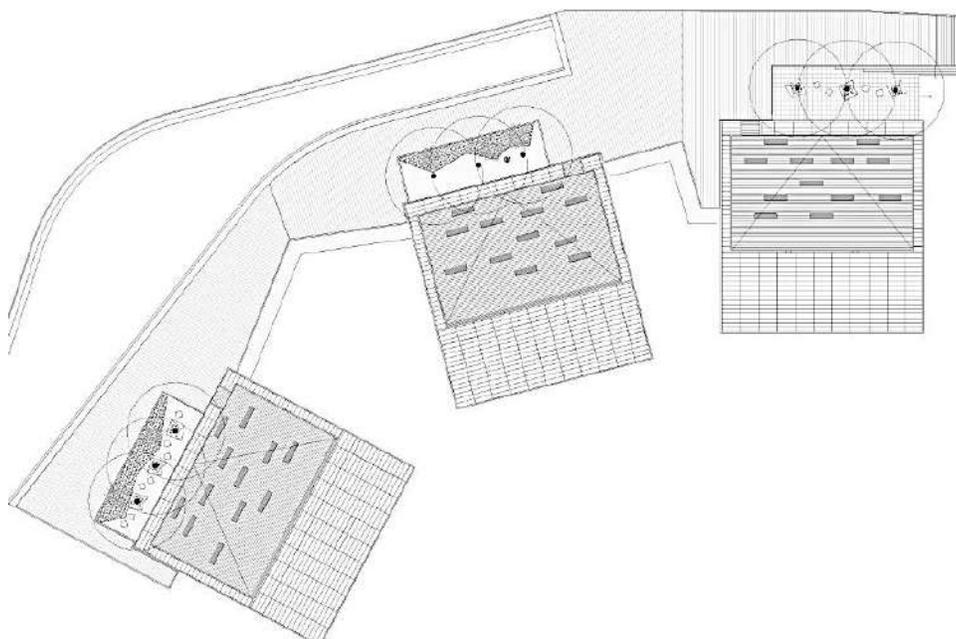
Planta cubierta del Parque Biblioteca León de Grieff.
